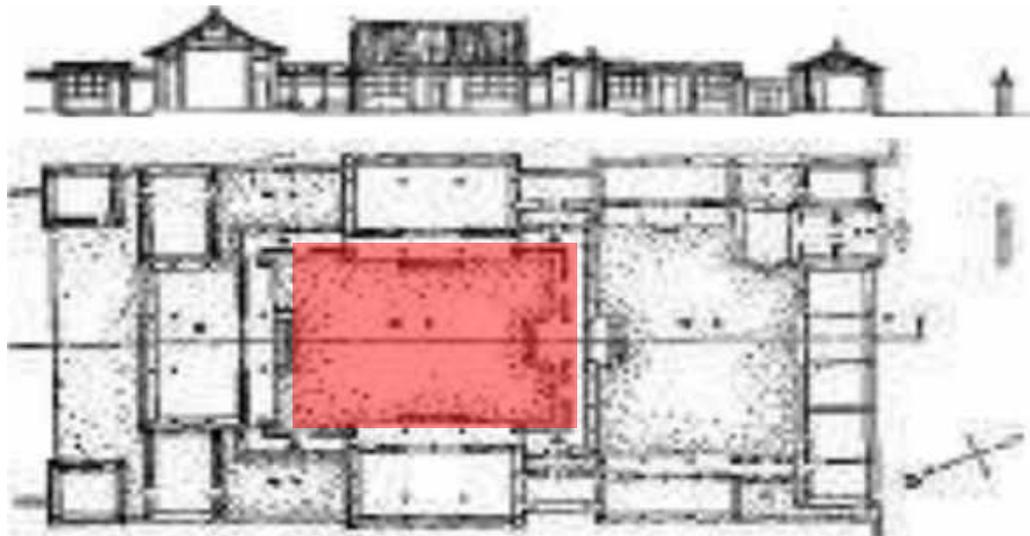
Site plan Beijing, di Dalam dan di Luar Kota
